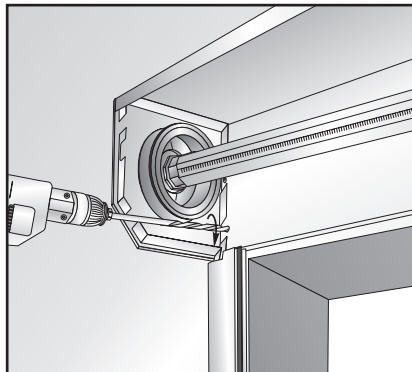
Разметка отверстия для ленточного и шнурового приводов
